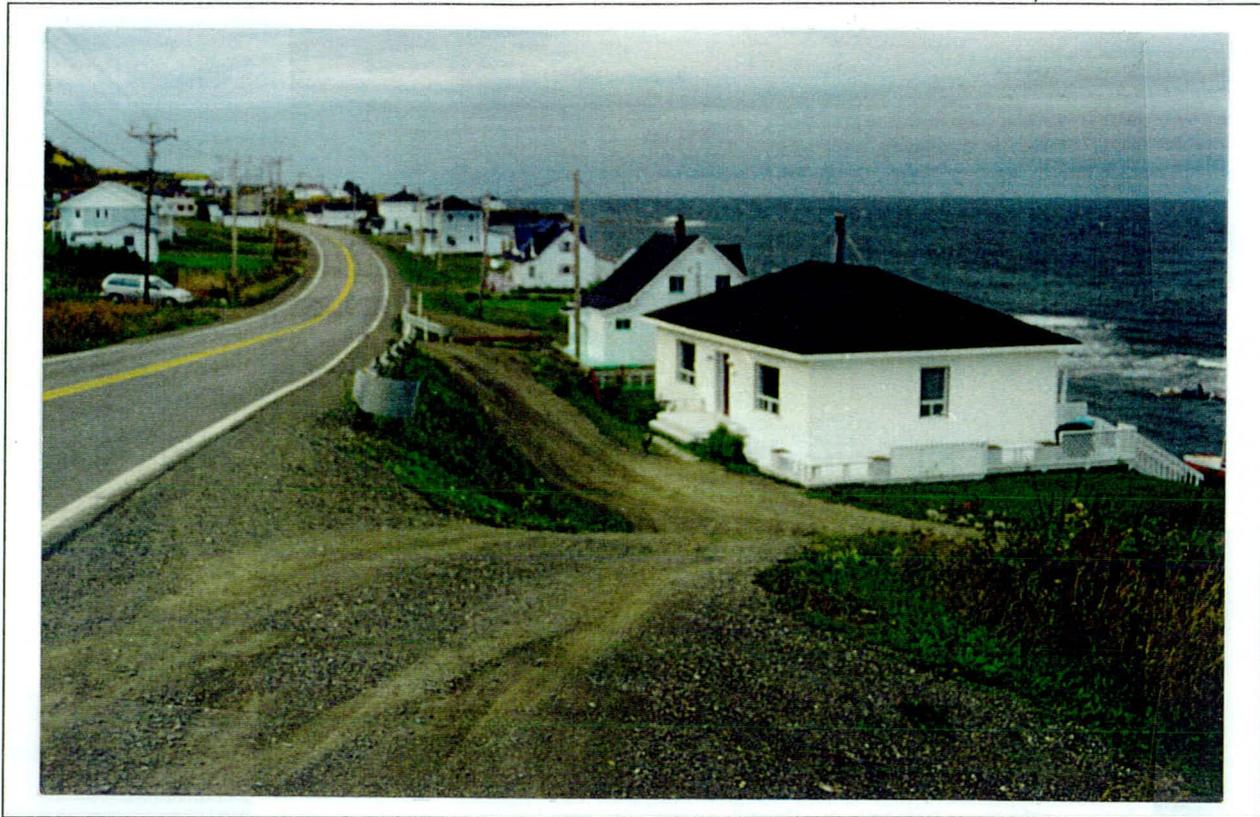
En arrière plan, aperçu de l'entrée privée de la résidence no. 231. À l'avant-plan, accès privé servant aux 2 résidences situées au bas du remblais de la route 132 (nos civiques 235 et 237).
